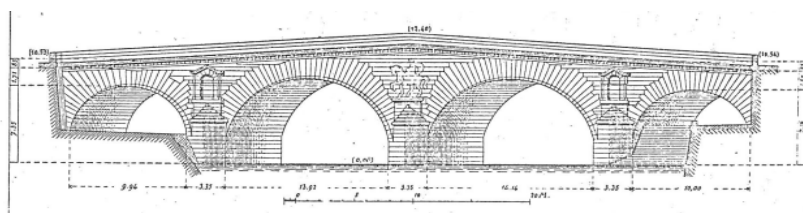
Coupe du pont Saint-Michel (Darche, 1986)
